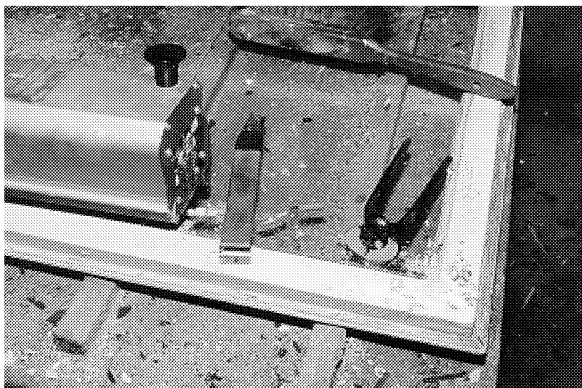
Överlufterna sågades av för att anpassa karmens yttermått till provningsutrustningen.
